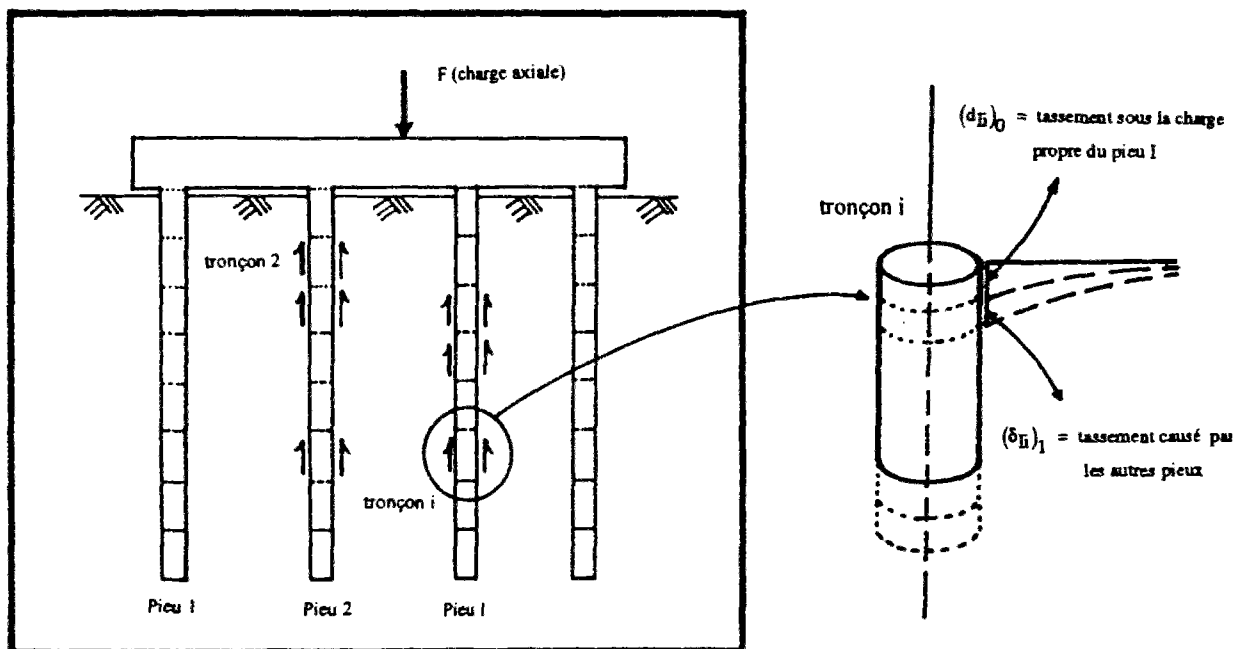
Tassement d'un tronçon de pieux dans le groupe
